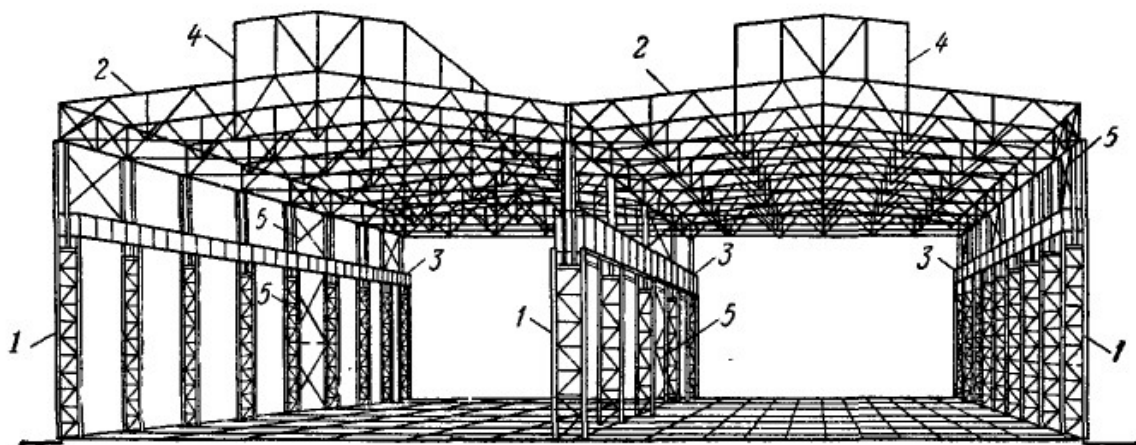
Конструктивная схема двух пролётного промышленного здания: 1- колонны; 2- фермы; 3- подкрановые балки; 4- П-образный светоаэрационный фонарь; 5 – связи по колоннам.
